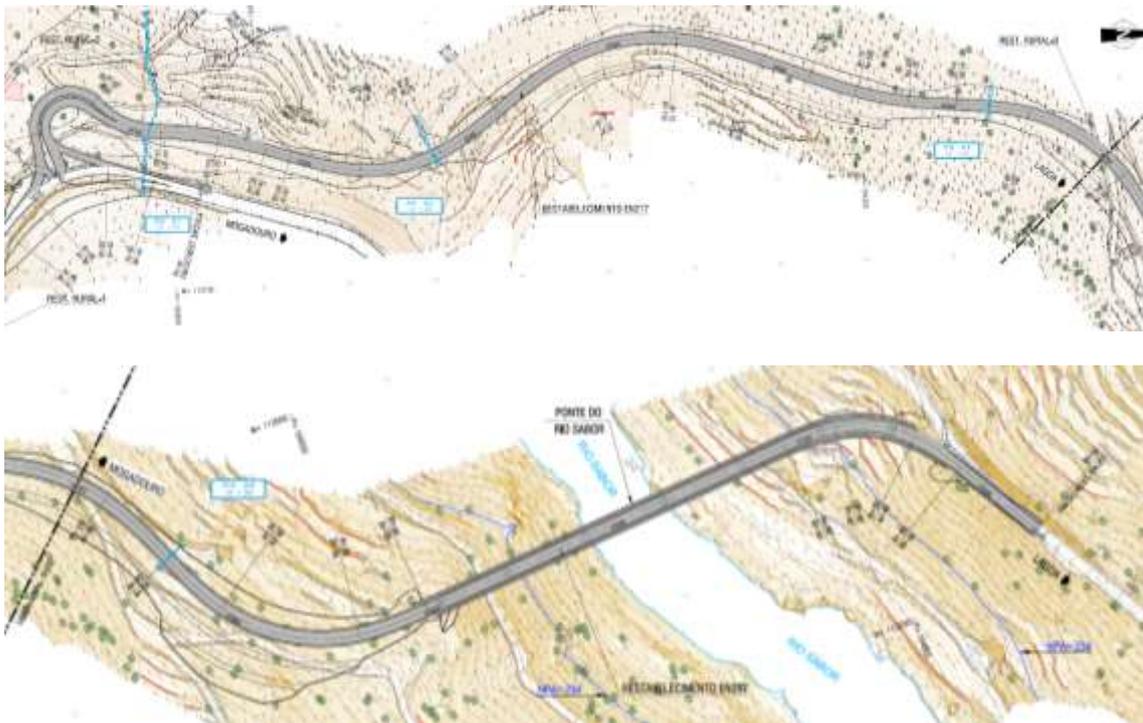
EN217 - Planta Longitudinal (43) (44)
